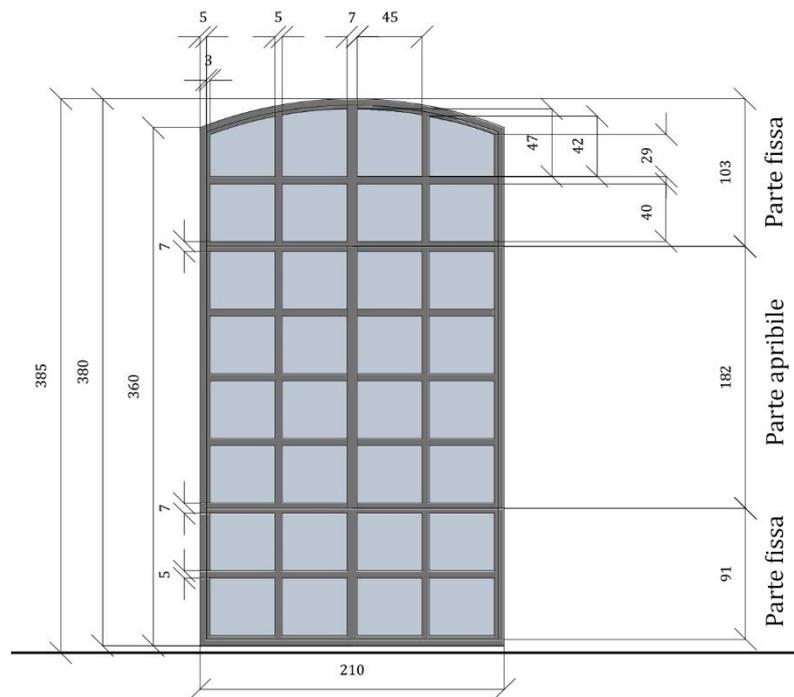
Prospetto in scala 1:50 della tipologia di finestra caratteristica del piano terra.
